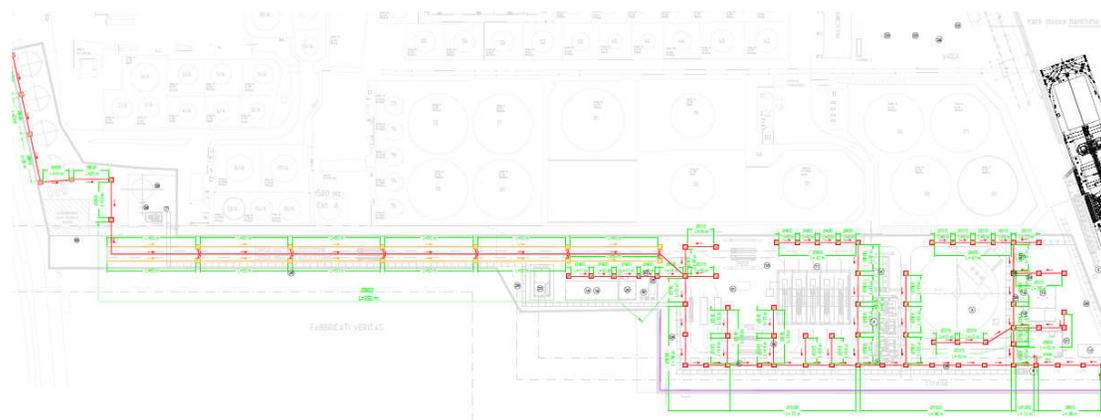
Planimetria Rete di Smaltimento Acque Meteoriche – Area Apparecchiature Principali
